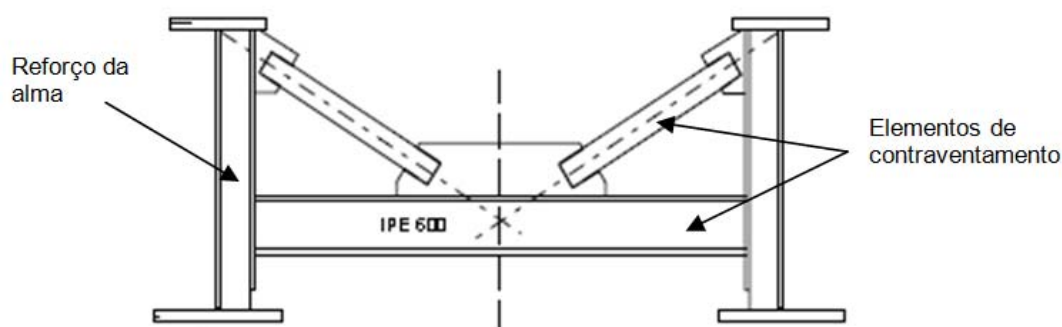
Secção transversal tipo da solução Bi-viga usado actualmente
